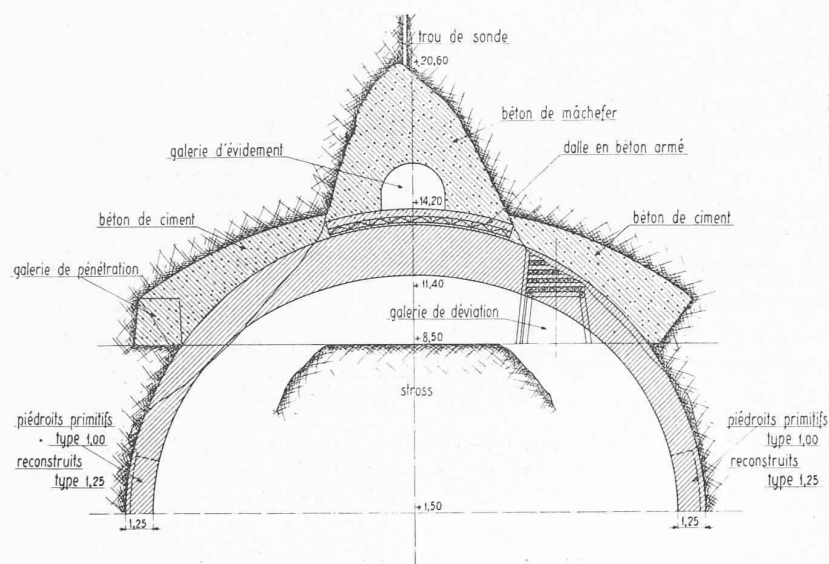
Coupe transversale sur l'anneau 103. — Echelle 1 : 300.
